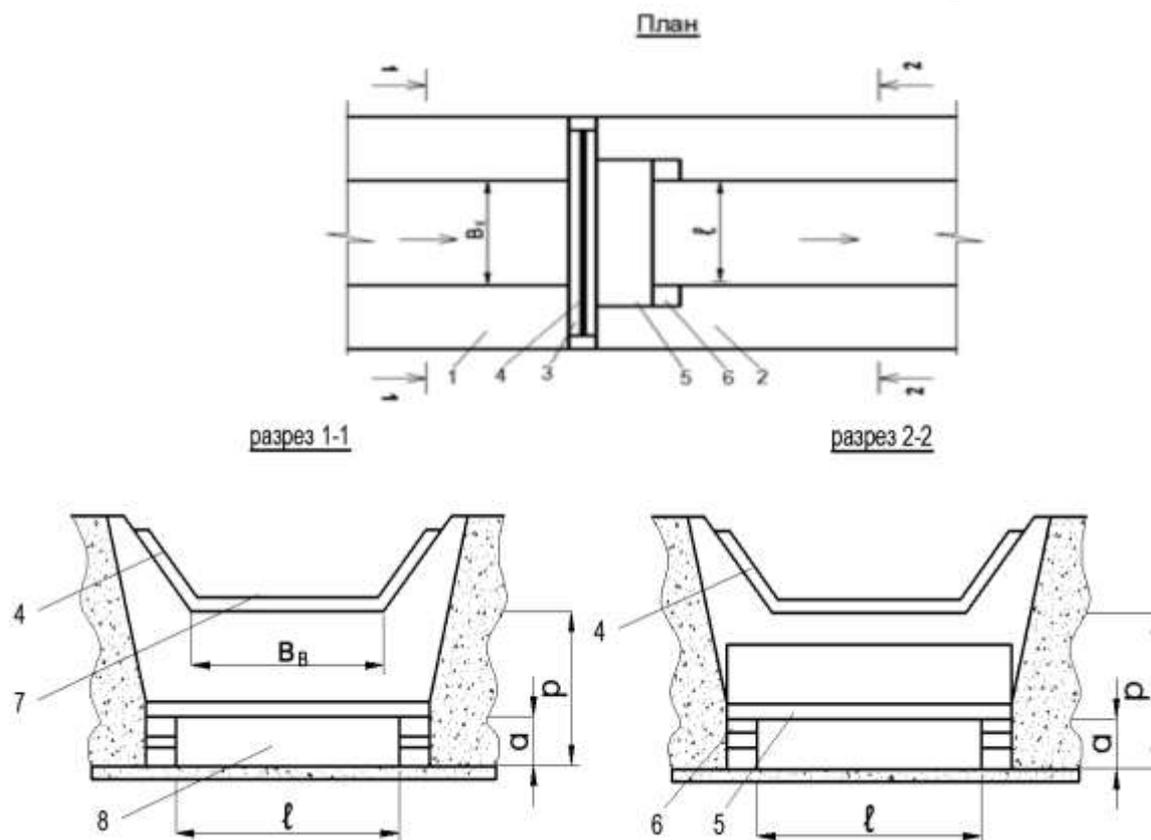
Схема комбинированного водомера типа «Водослив-прямоугольный насадок» применительно к водотоку трапецеидального сечения (изготавливается только из бетона).
